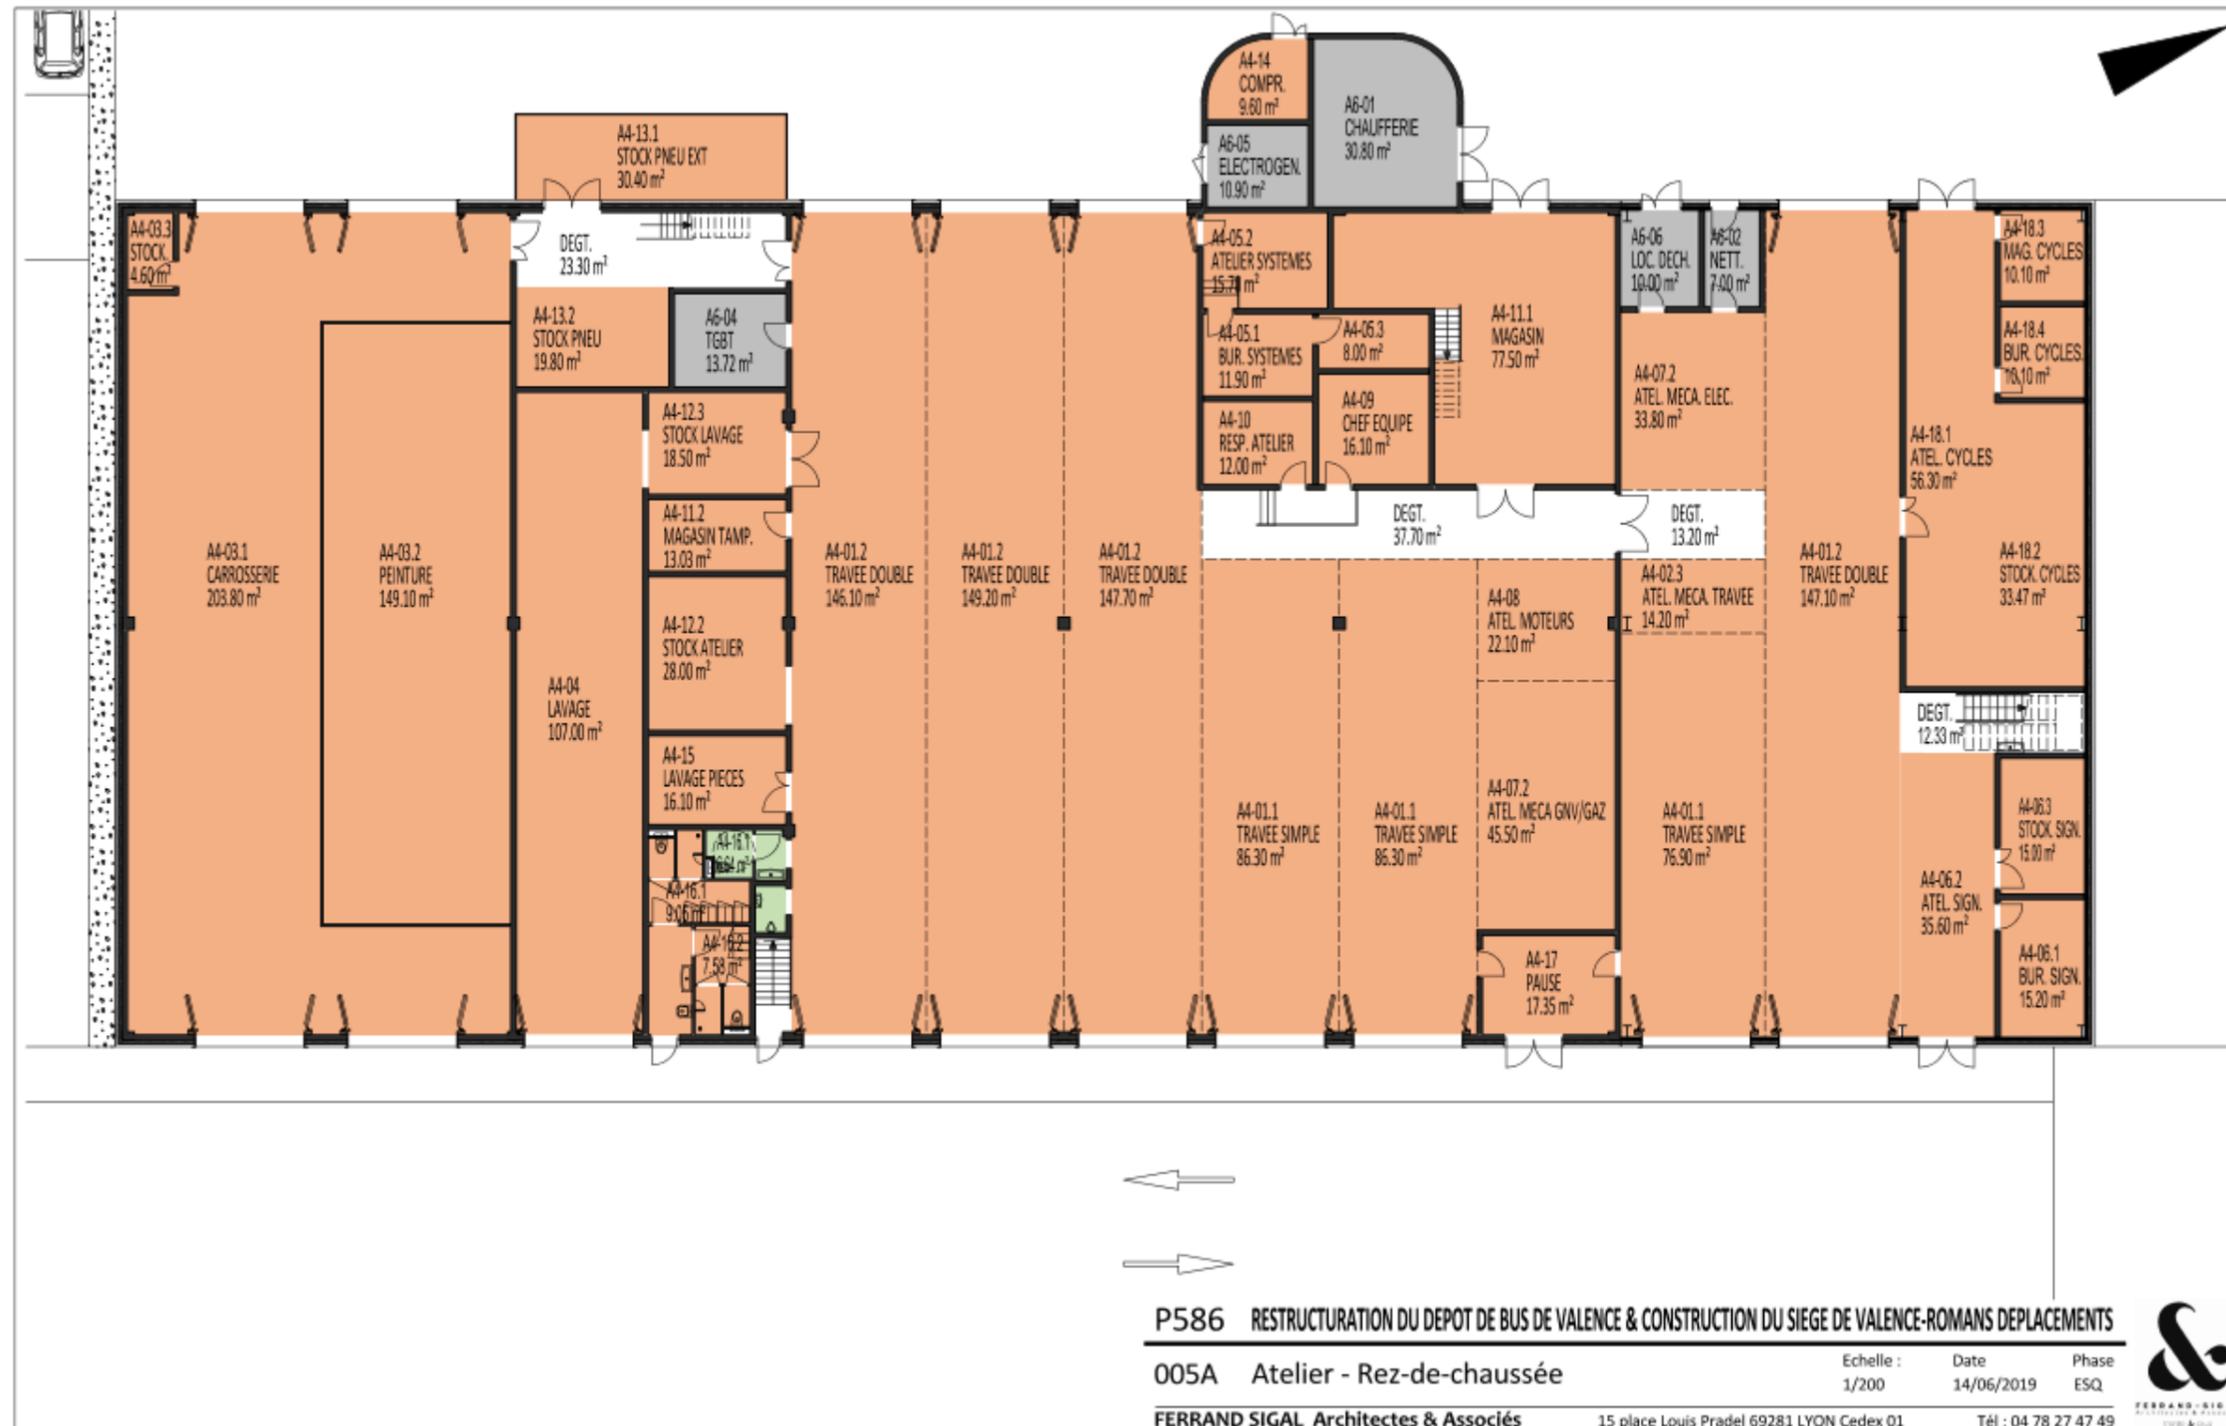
Plan Atelier – RDC (Ferrand-Sigal, 2019)
